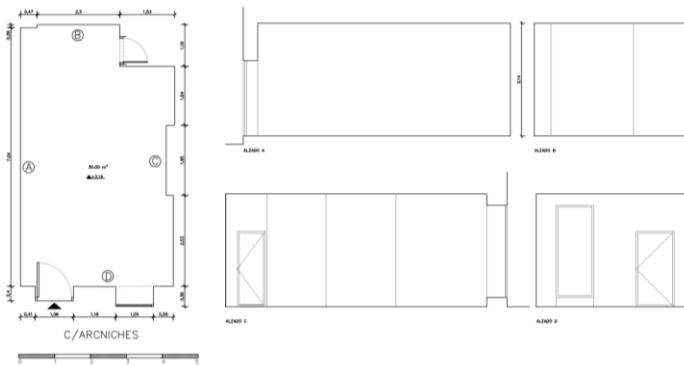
plano de la Galería Arniches 26 de Madrid.
